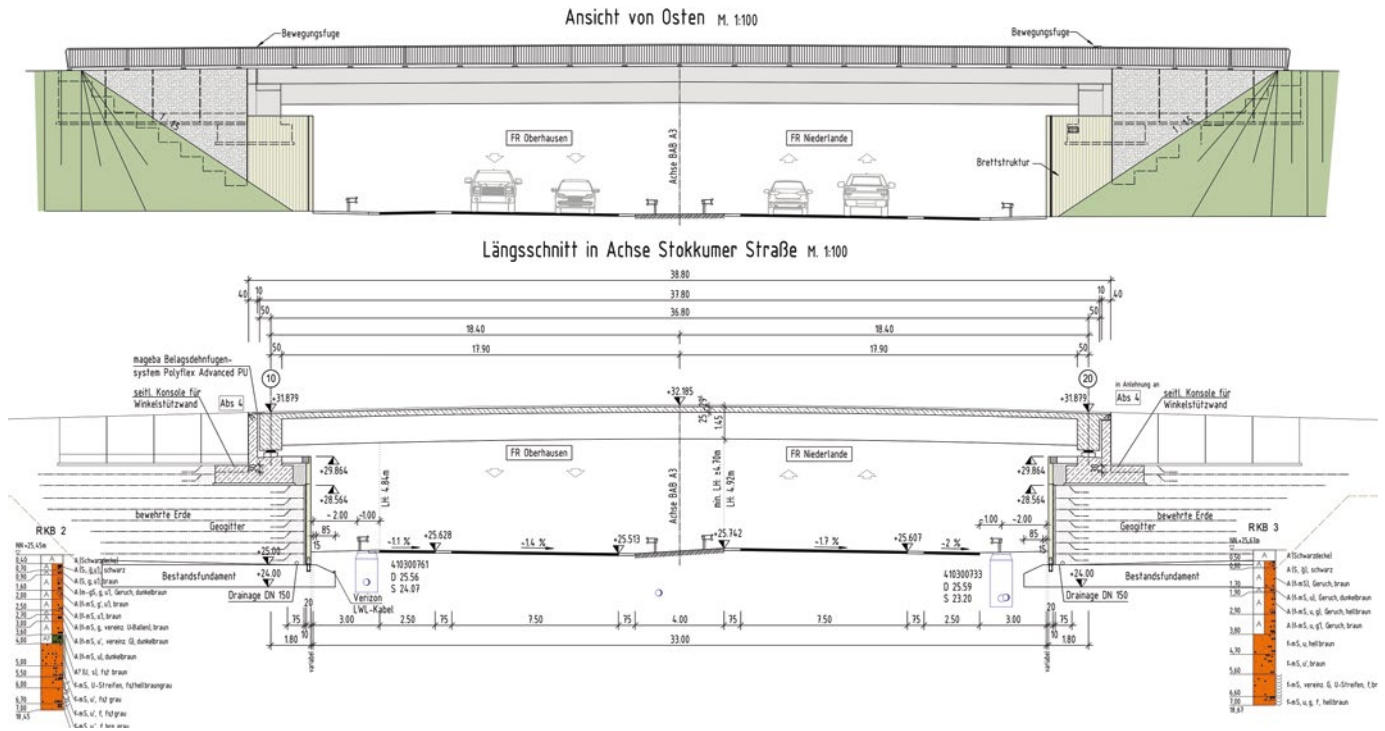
Bauwerksentwurf – Ansicht und Längsschnitt
